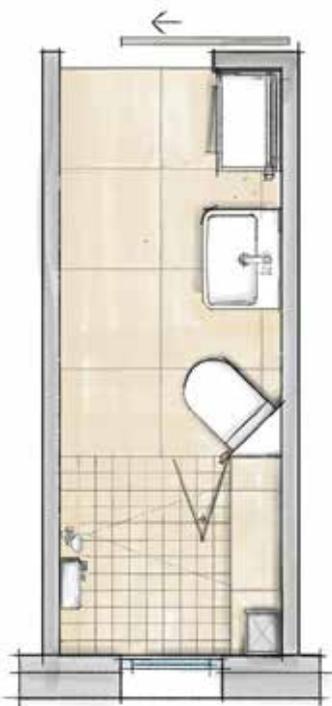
Umbauvariante 6 – Schlauchbad mit Assistenz an Waschtisch und Toilette (Grundriss: DLW)
